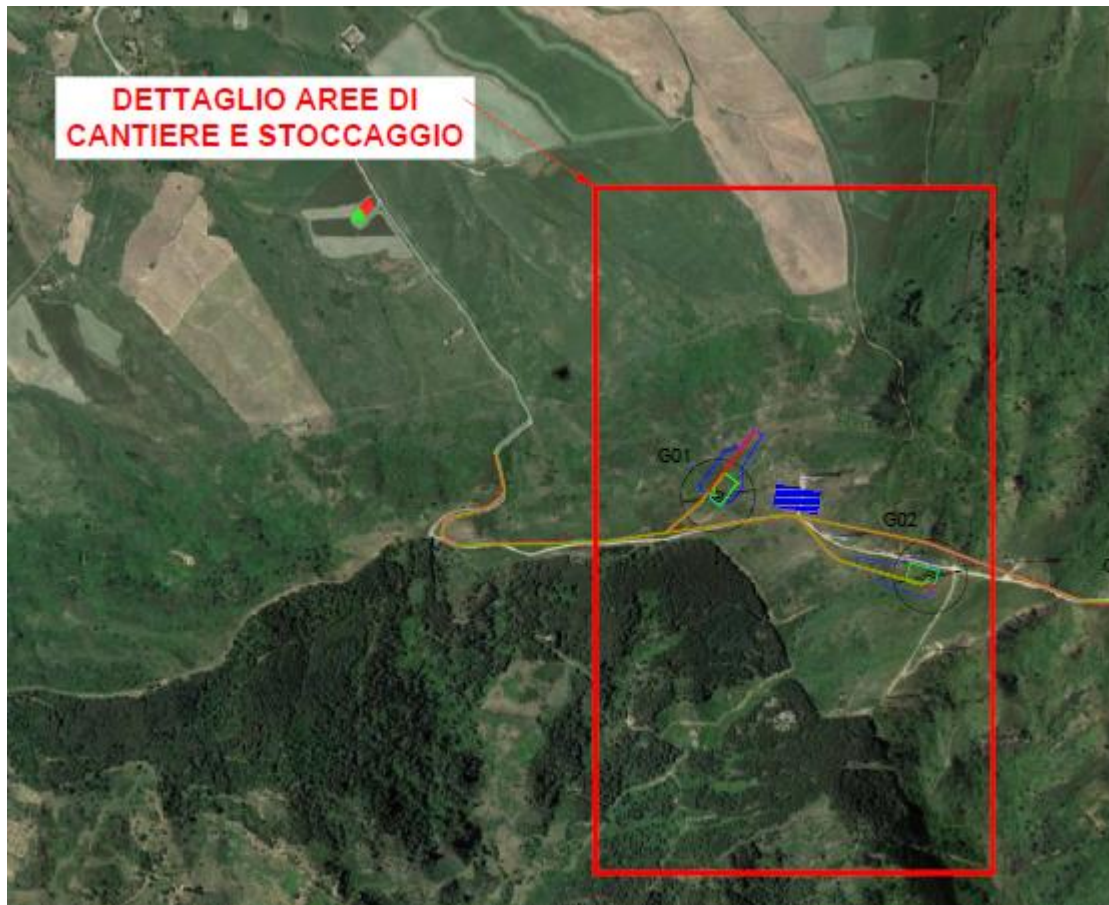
Area di cantiere (Site camp) su ortofoto
